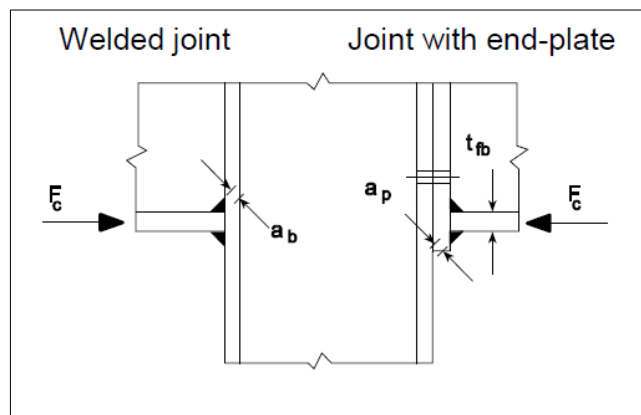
Tamaño de soldadura (garganta efectiva) para conexiones soldadas y con placa (EN, 1993-1-8)
